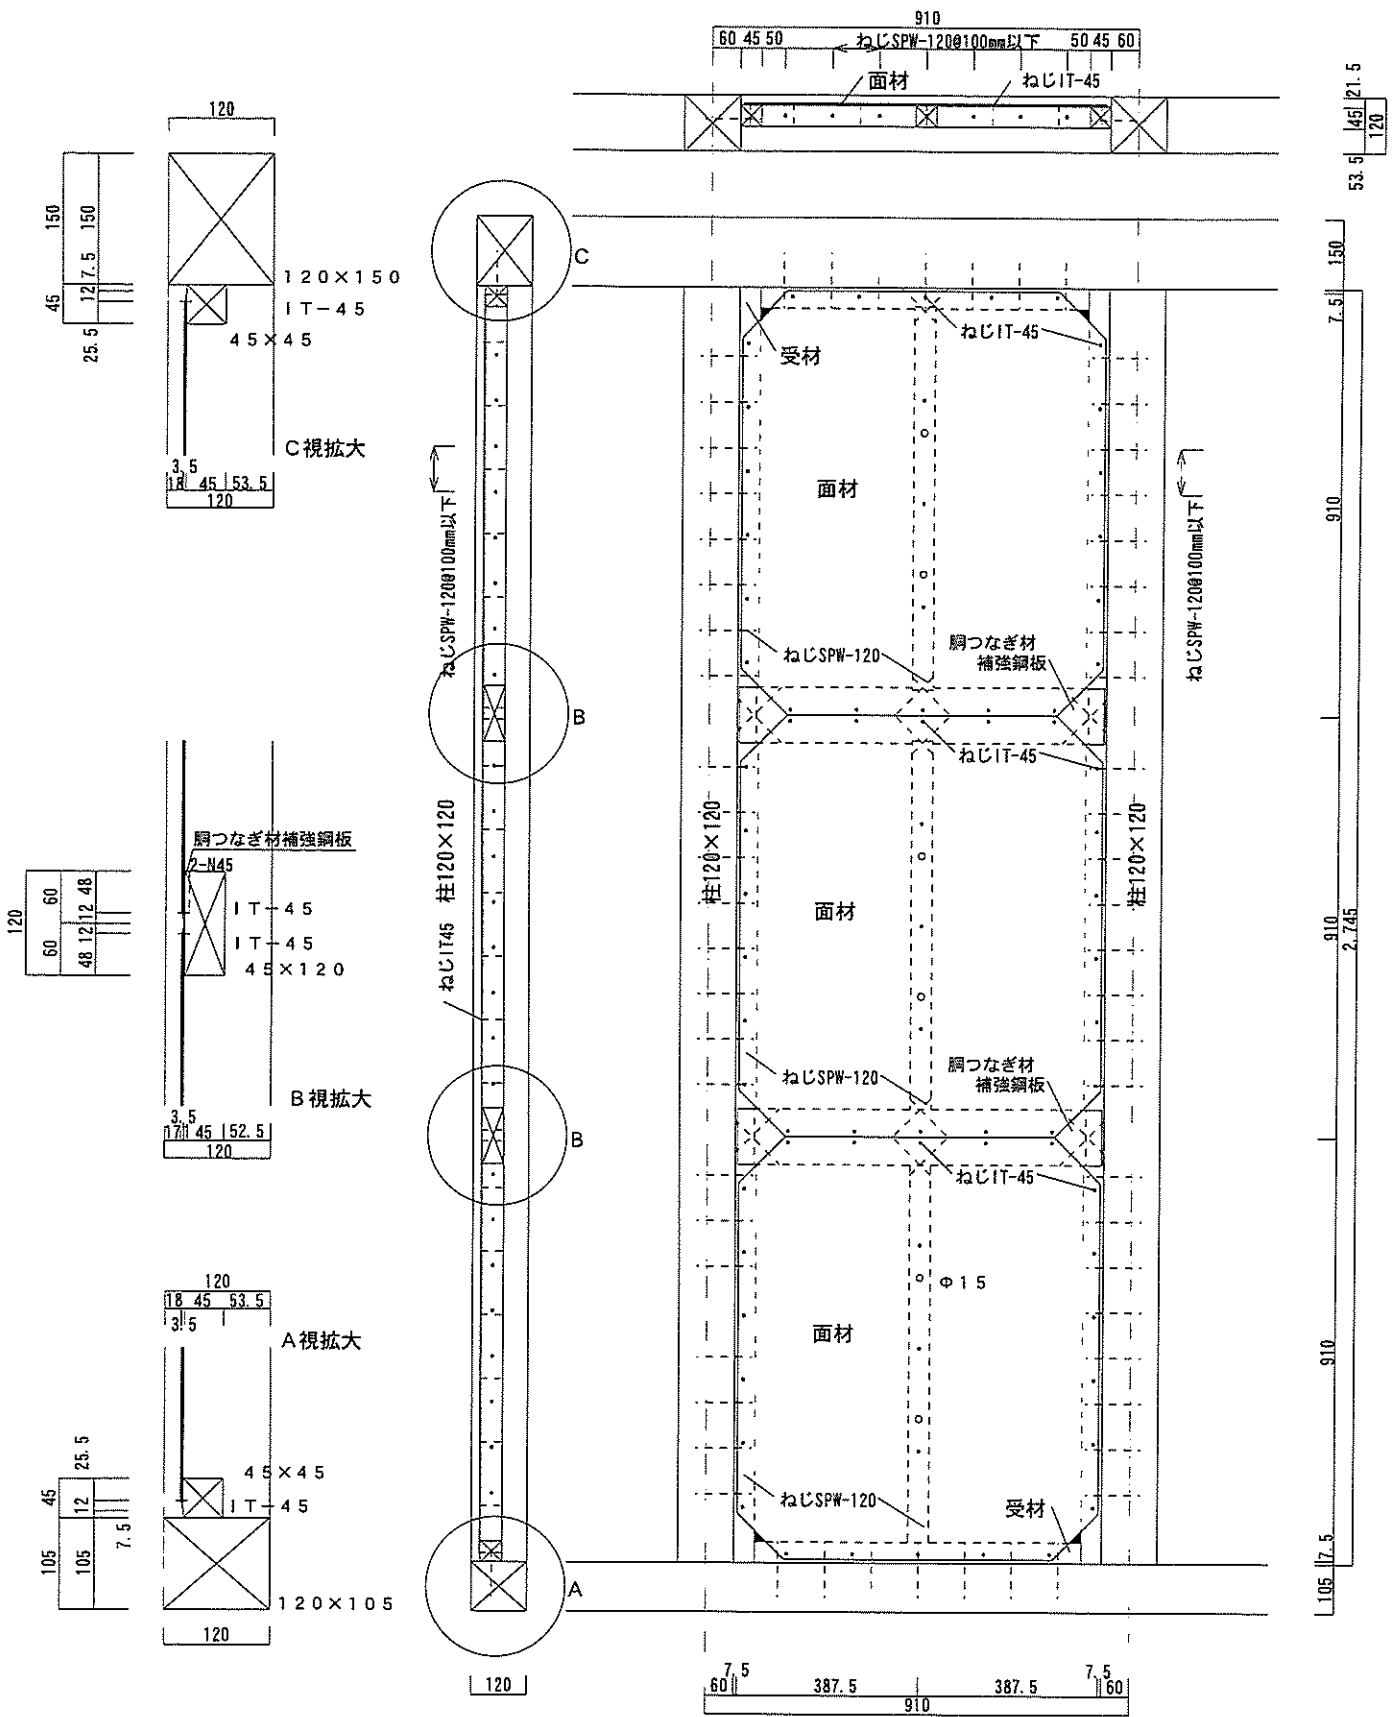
施工図 (柱寸法: 120×120mm、壁高さ最小時) (寸法単位: mm)
